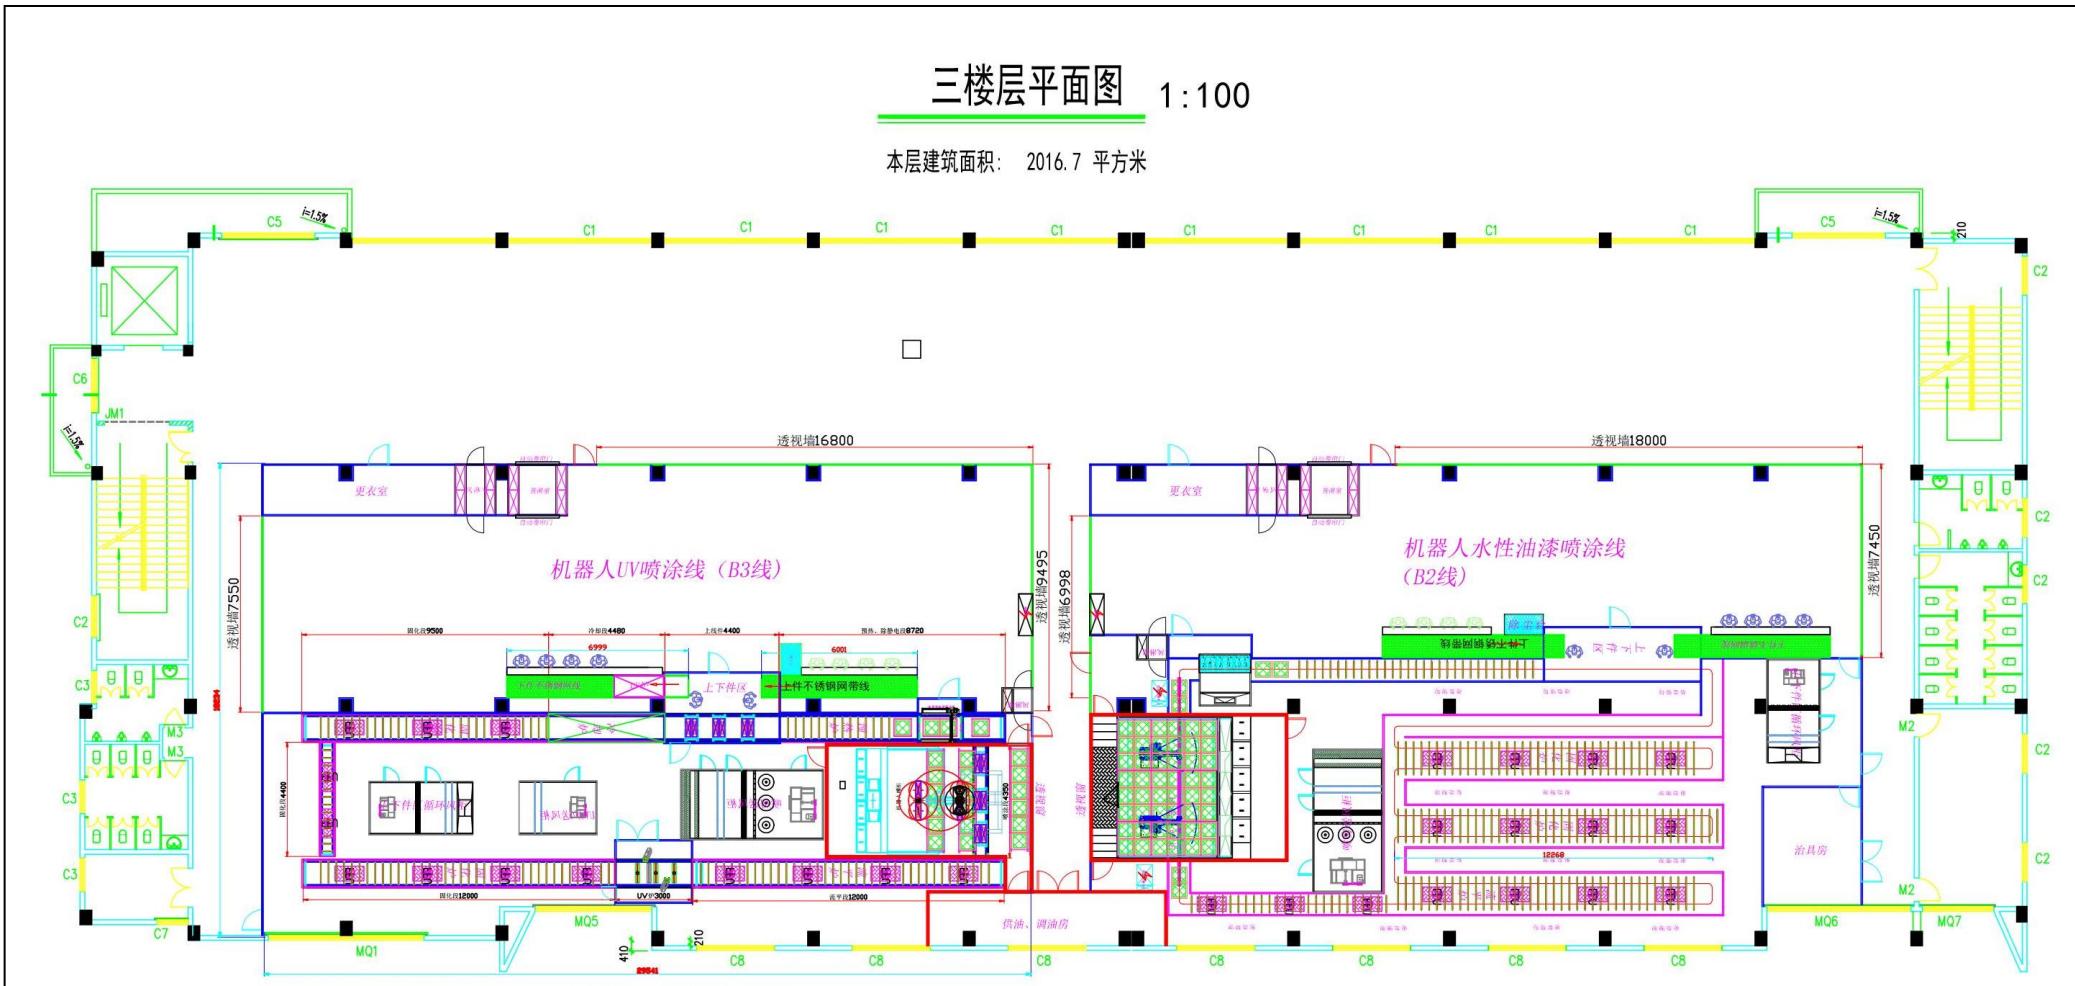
项目三楼 B2 及 B3 喷涂线平面布置图
